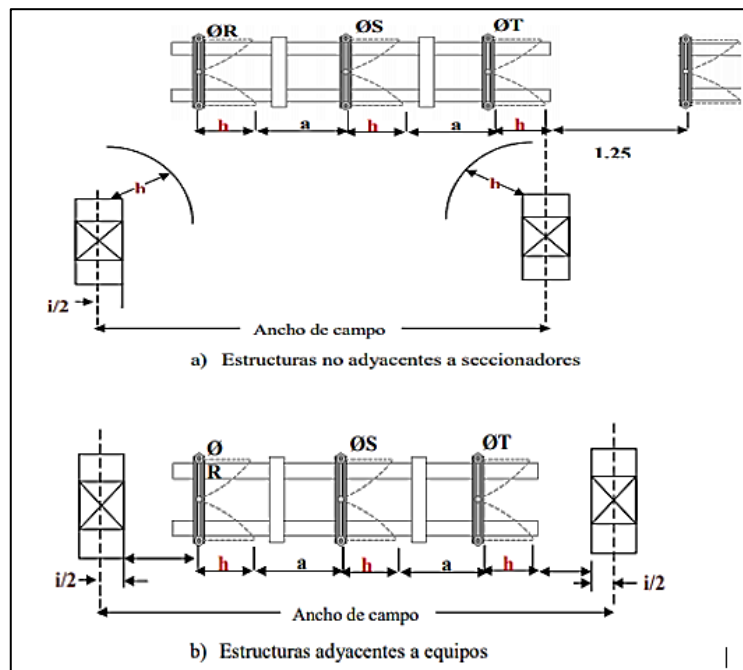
Ancho de campo con seccionadores de apertura central [16].
